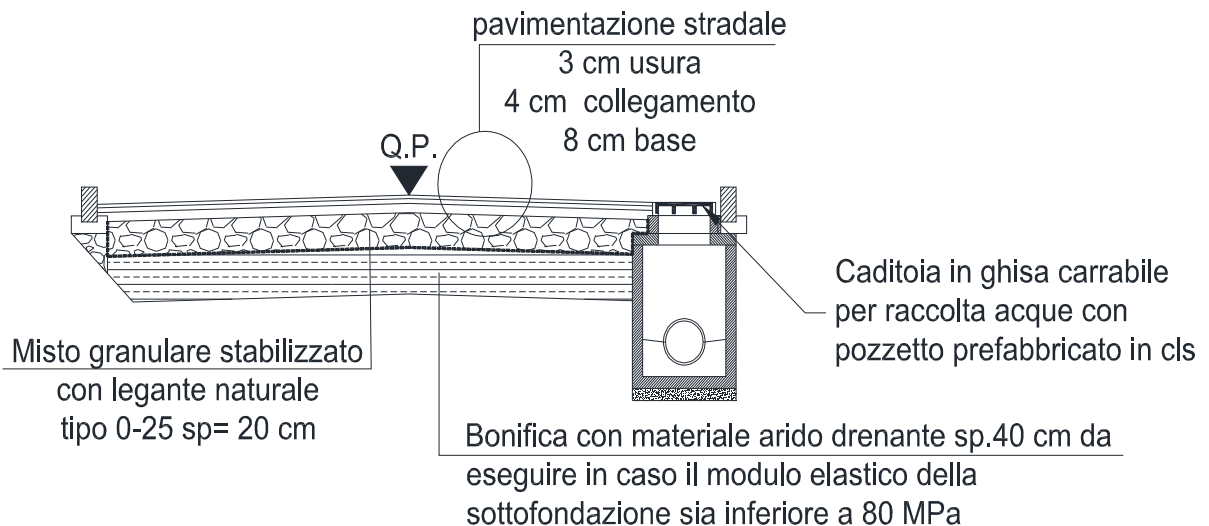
Pavimentazione per Strada di Cantiere Fase Finale
